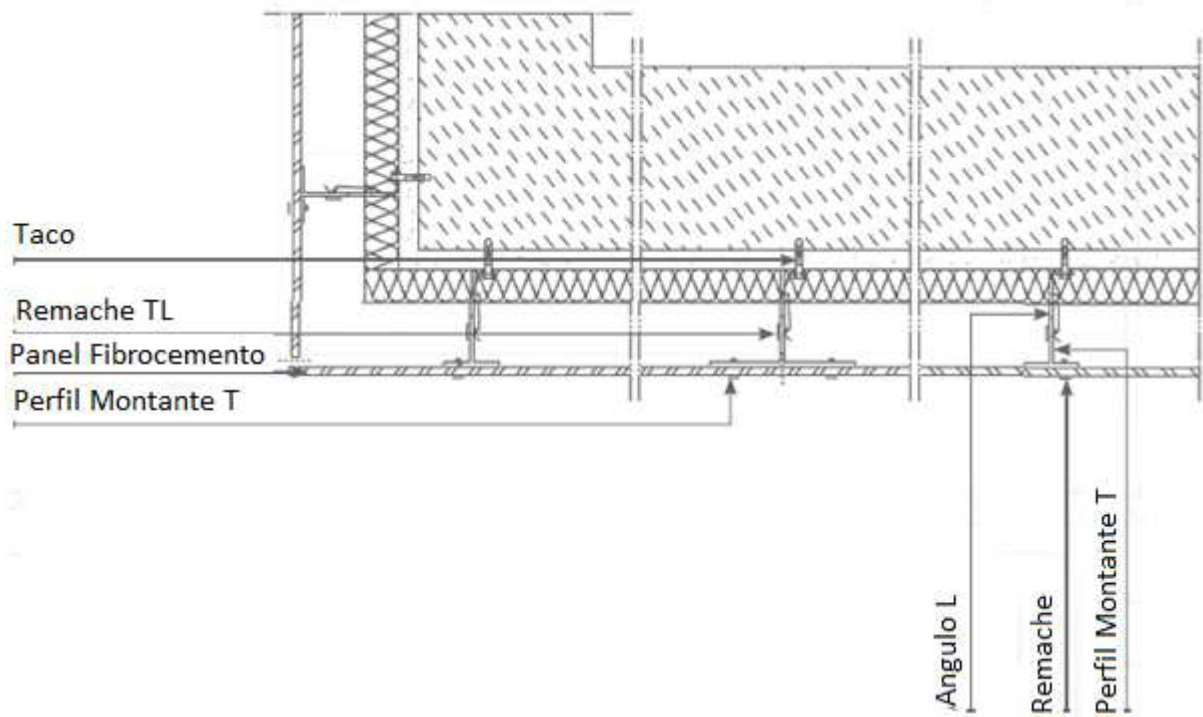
Vista en planta de detalle de instalación de fachada ventilada [10]
